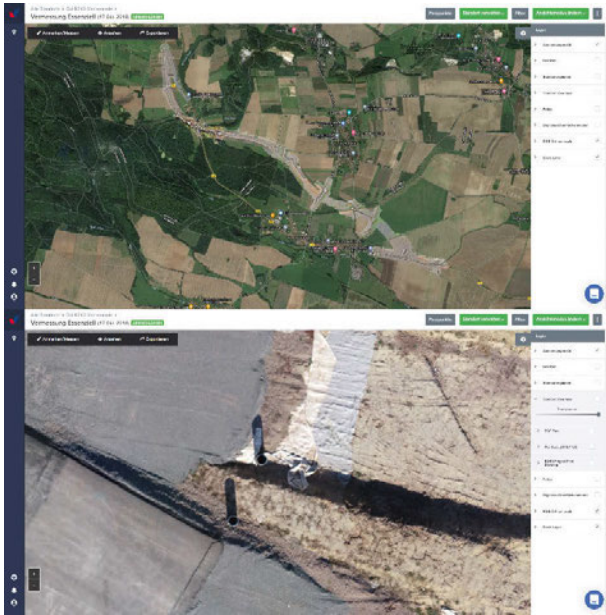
Gesamtüberblick und Detailansicht eines 5 km langen Straßenbauprojekts
